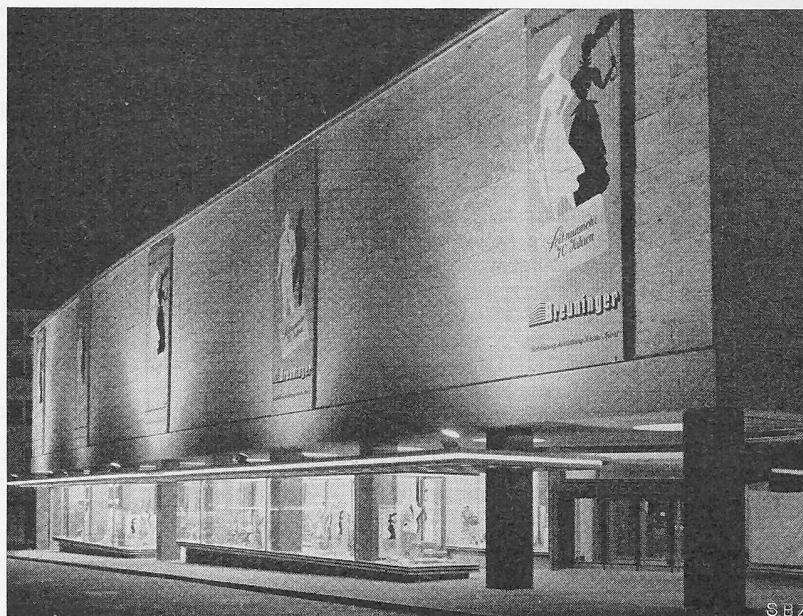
Erdgeschoss fertig, Obergeschosse provisorisch verkleidet
